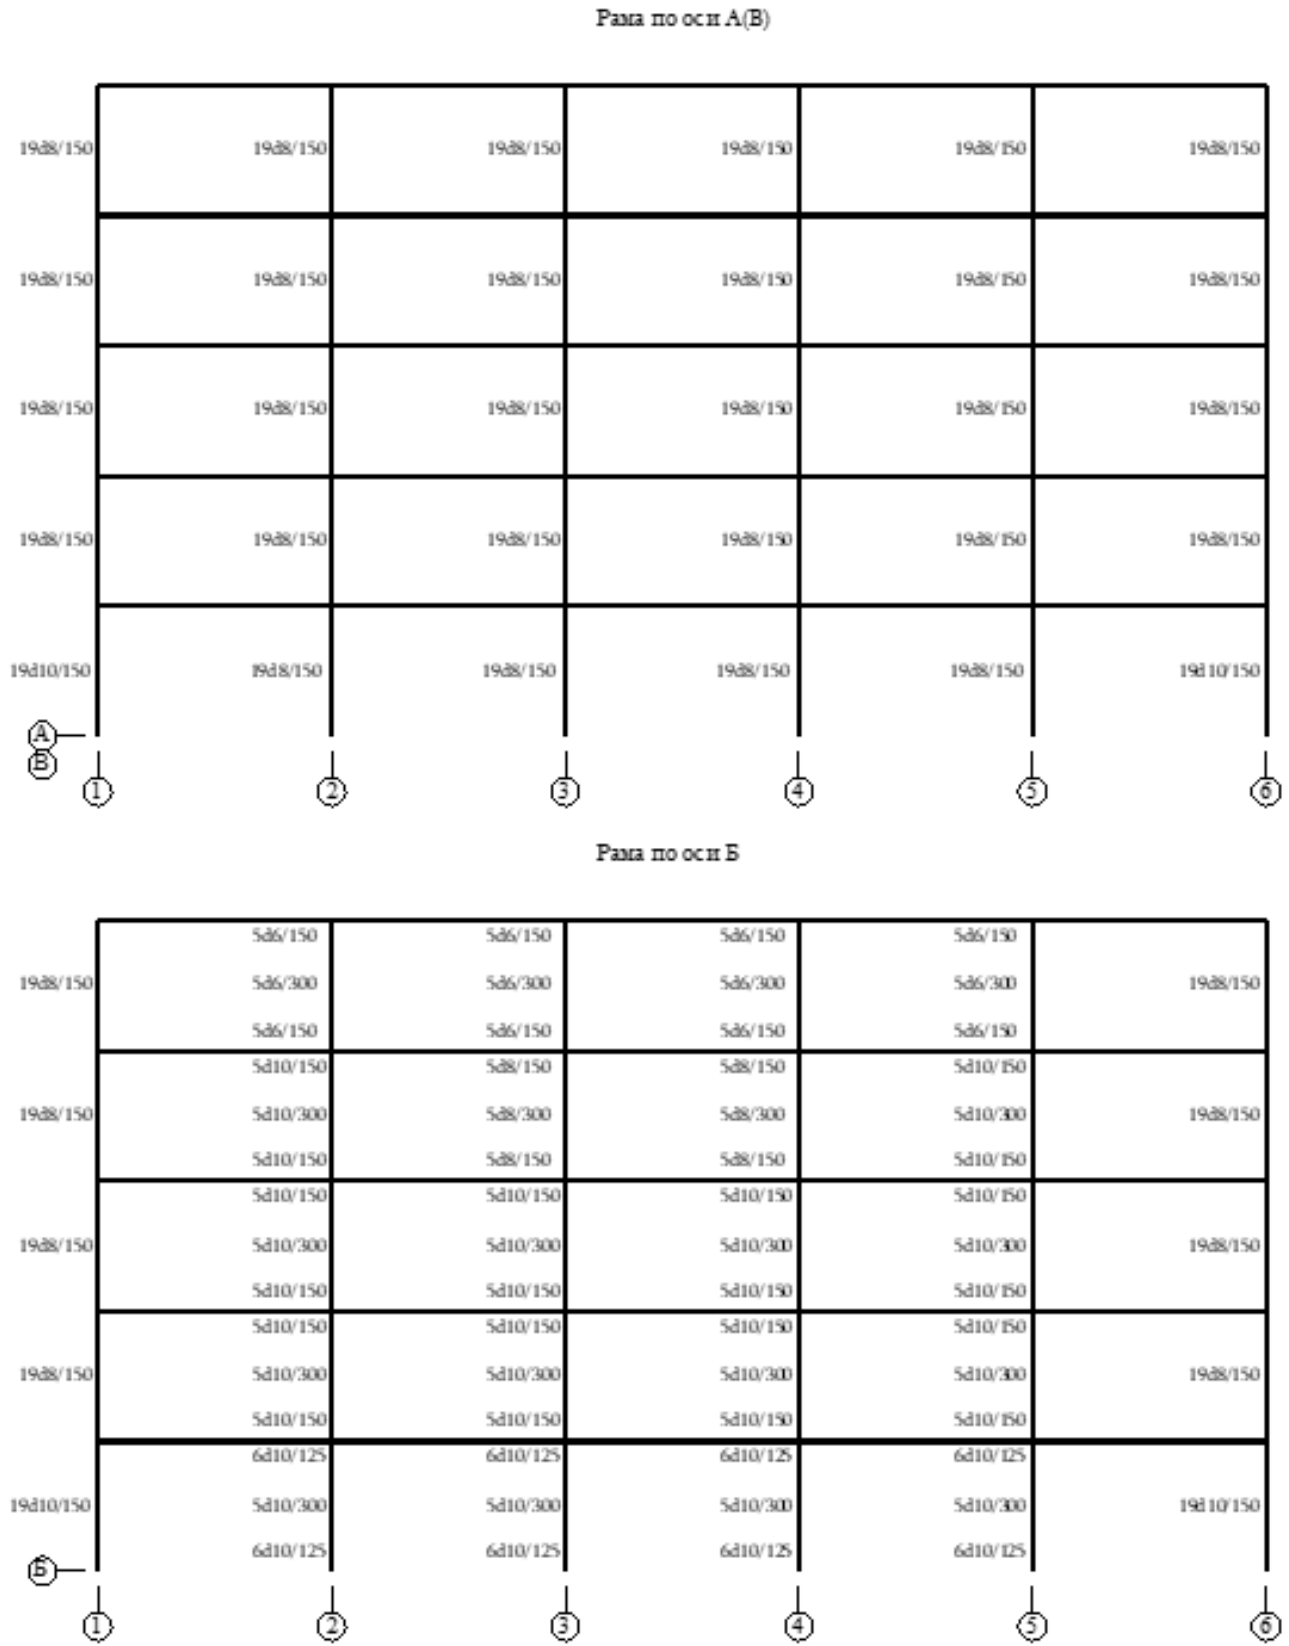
Поперечное армирование колонн в соответствии с результатами расчета
